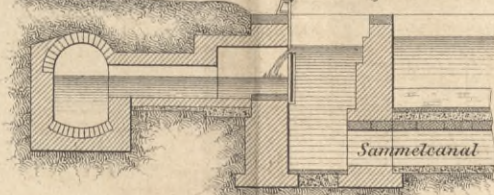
Grundriss des Abfluss-Brunnens
